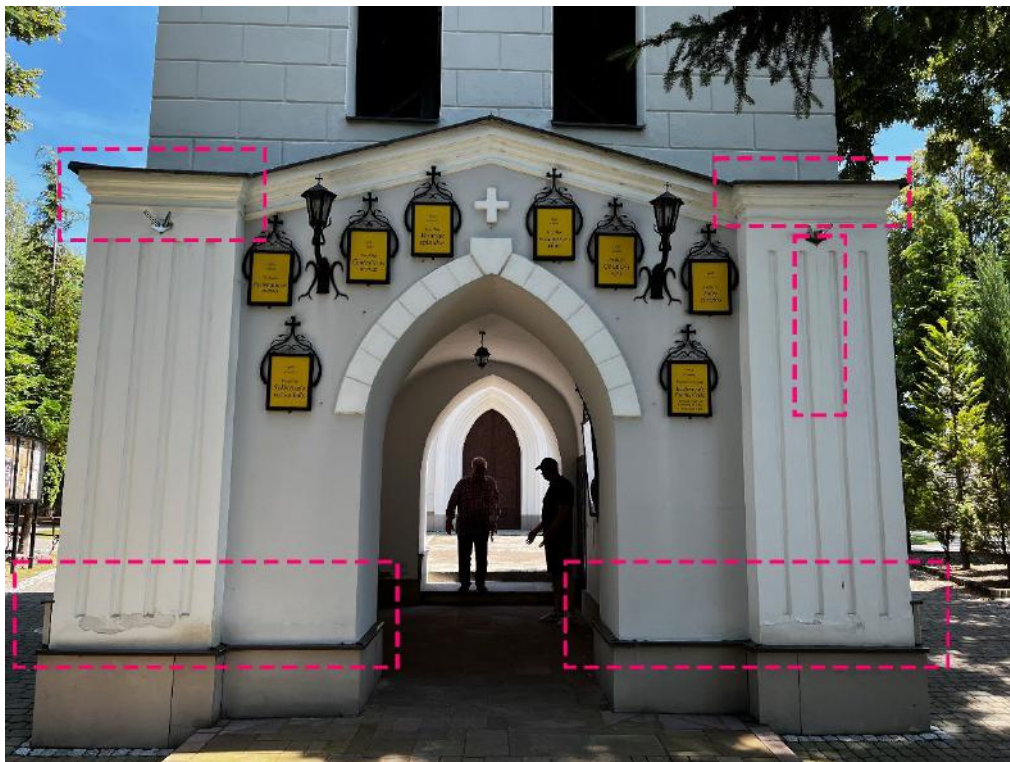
Zniszczenia na elewacji bocznej budynku kościoła (elewacja zachodnia).
